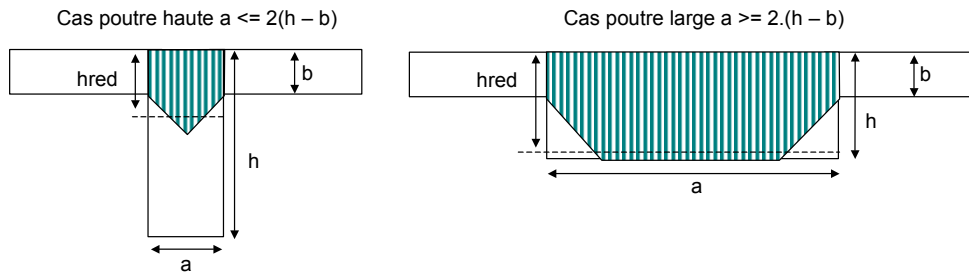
Calcul de la hauteur réduite selon le cas : poutre haute ou poutre large
